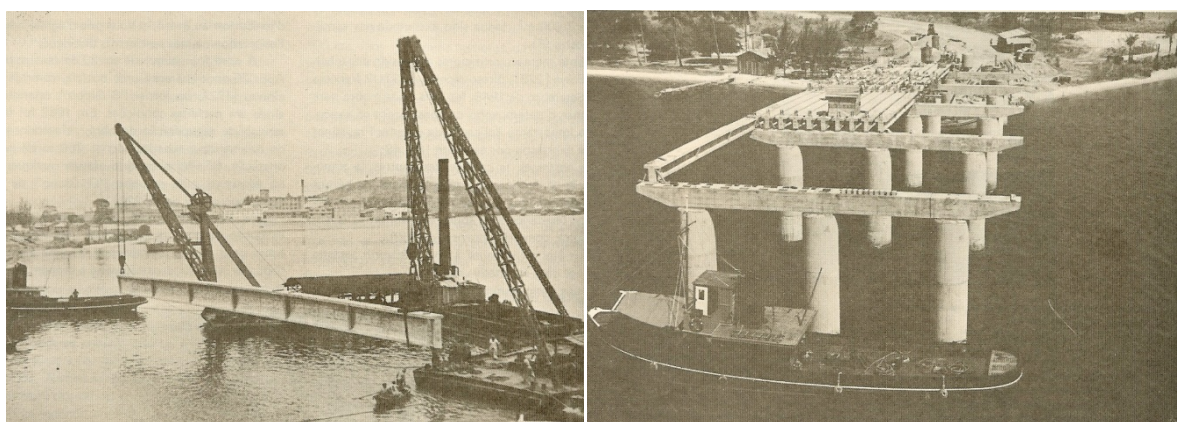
Ponte do Galeão: viga protendida pré-fabricada sendo transportada, e tabuleiro da ponte sendo montado com as vigas
